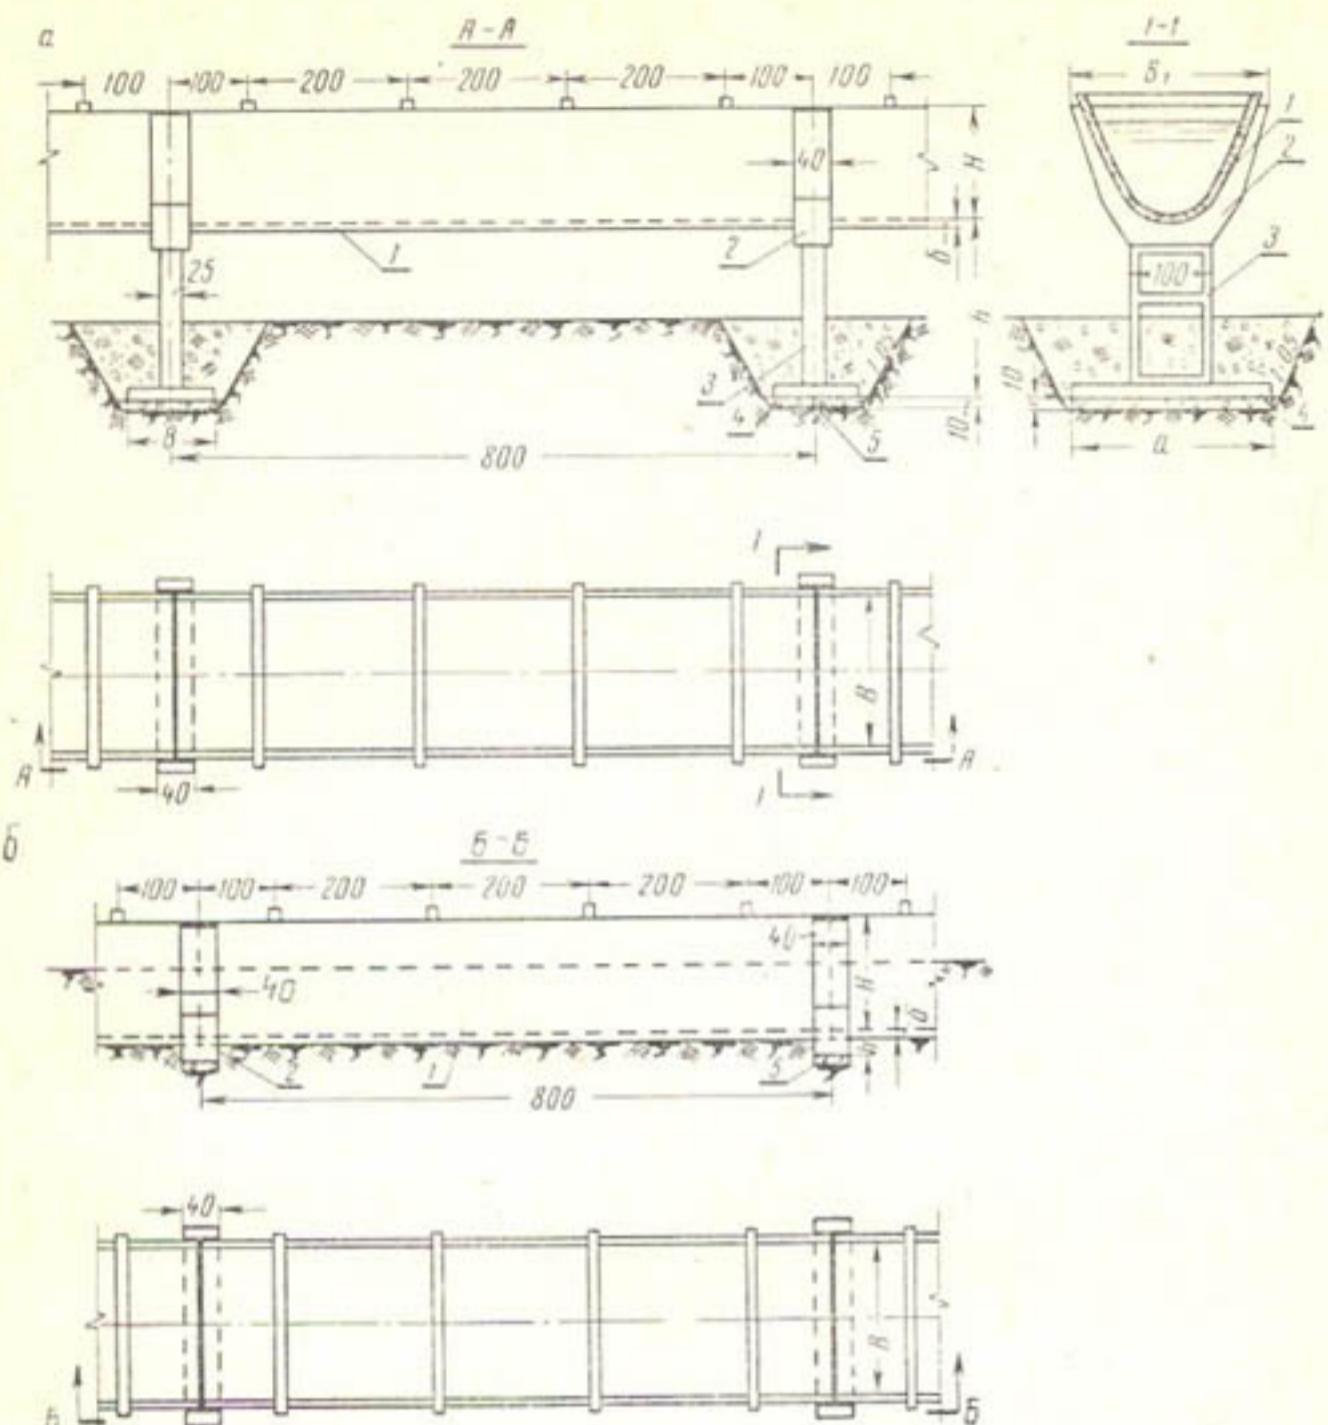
Параболические лотки из напряженного железобетона с пролетом 8 м:
